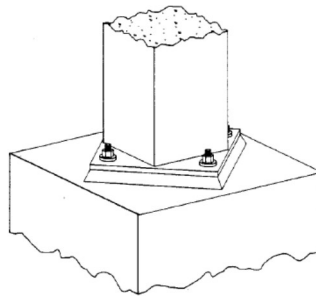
Ligação por ancoragem parafusada (Levy, 2000)
